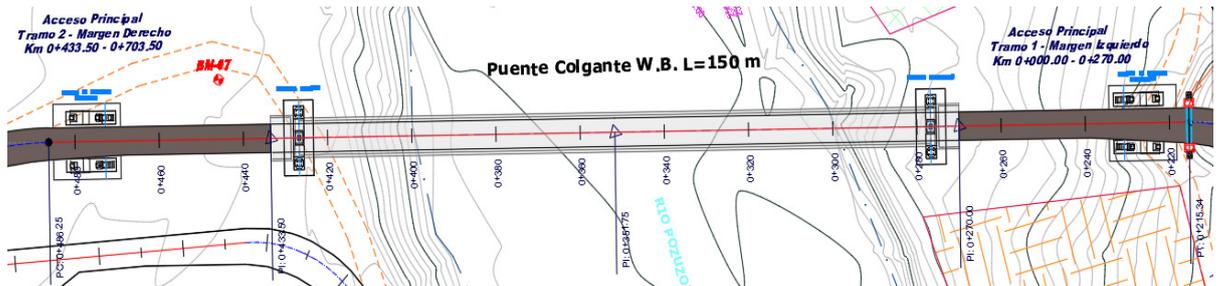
vista en planta puente l=150m (fuente: consultor de obra – ing. Llanos)
